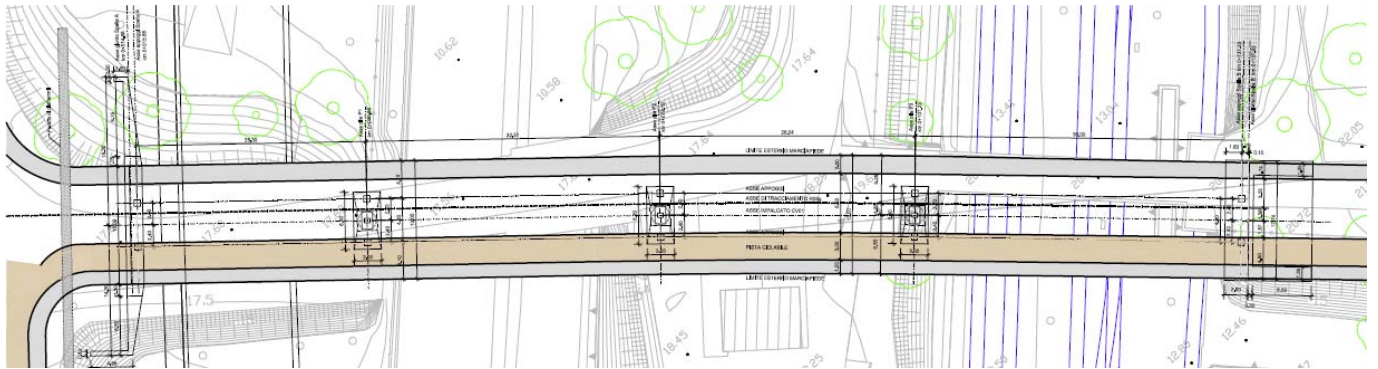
Cavalcavia CV01 - Pianta Impalcato.
